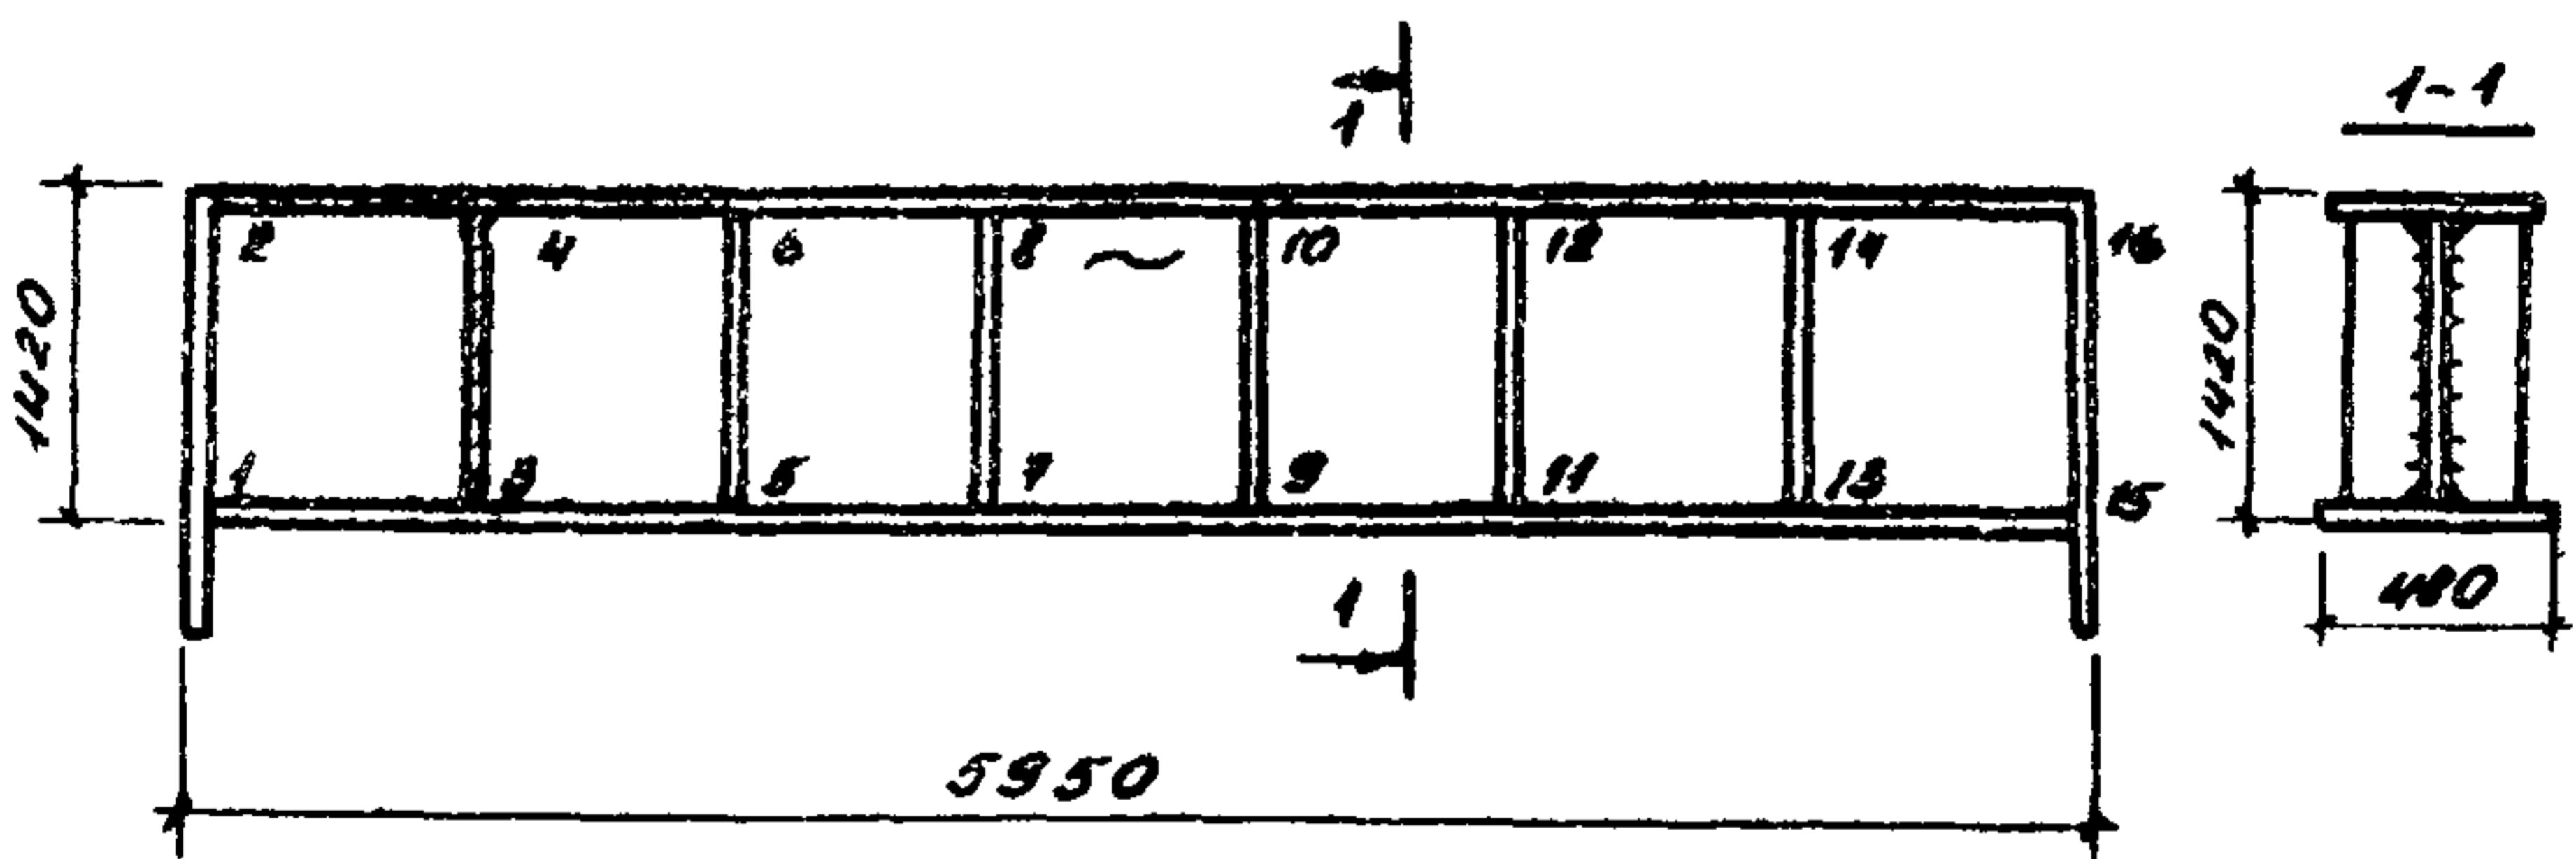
Подкрановая балка (БК) в осях 23-24 ряда В пролета ВГ
